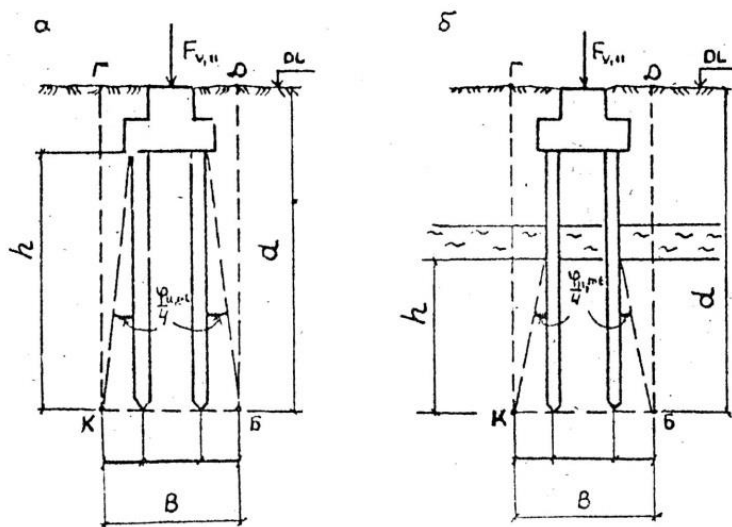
Схема определения условного фундамента: а – при отсутствии слабых грунтов; б – при наличии слабых грунтов толщиной более 30 см.
